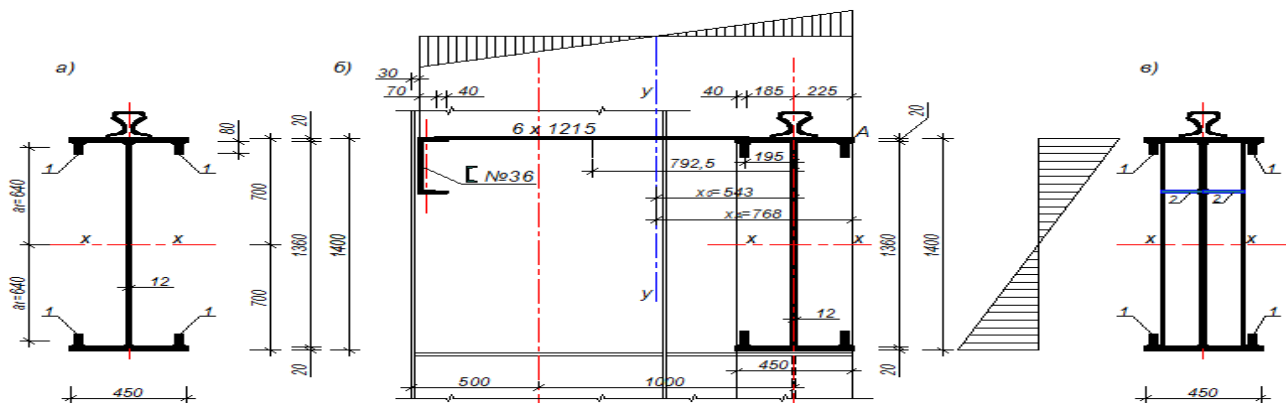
Сечение подкрановой балки: а) усиление по способу IV; б) к расчету подкрановой балки; в) установка продольных ребер жесткости: 1 – 80x20; 2 – 150x10.
